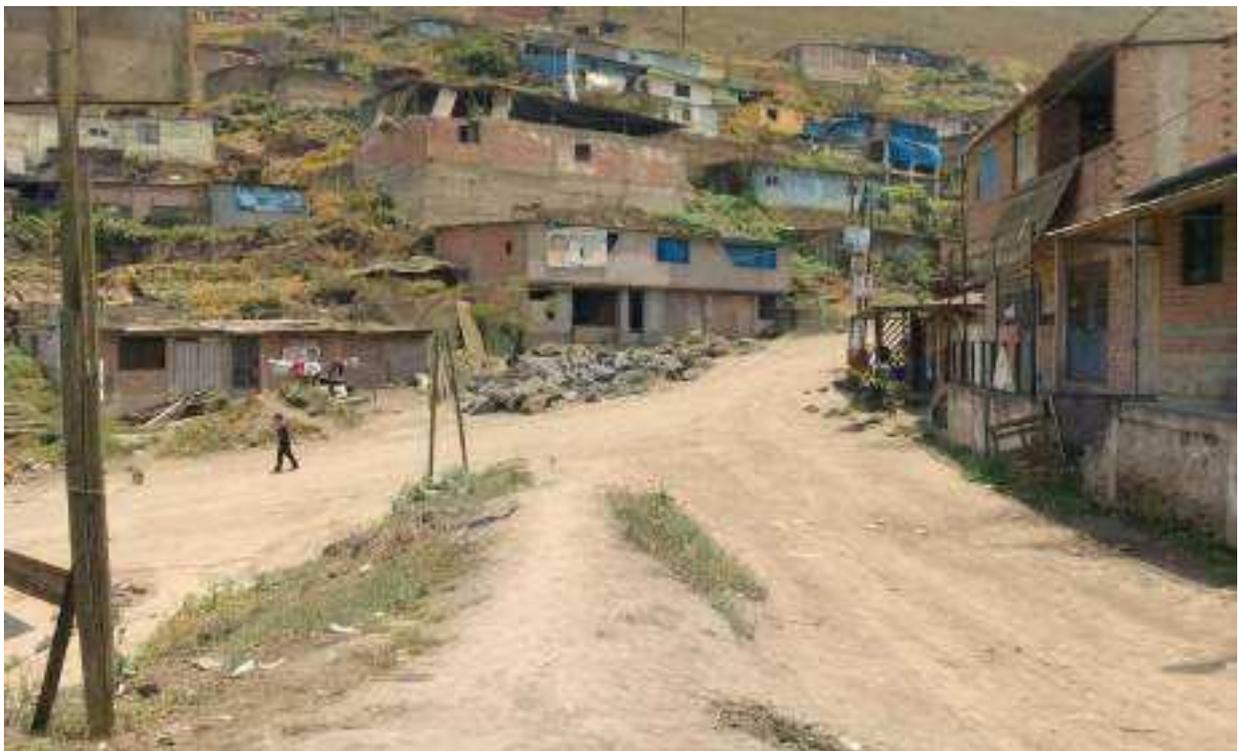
Vías sin planteamiento y zona de viviendas convencionales
